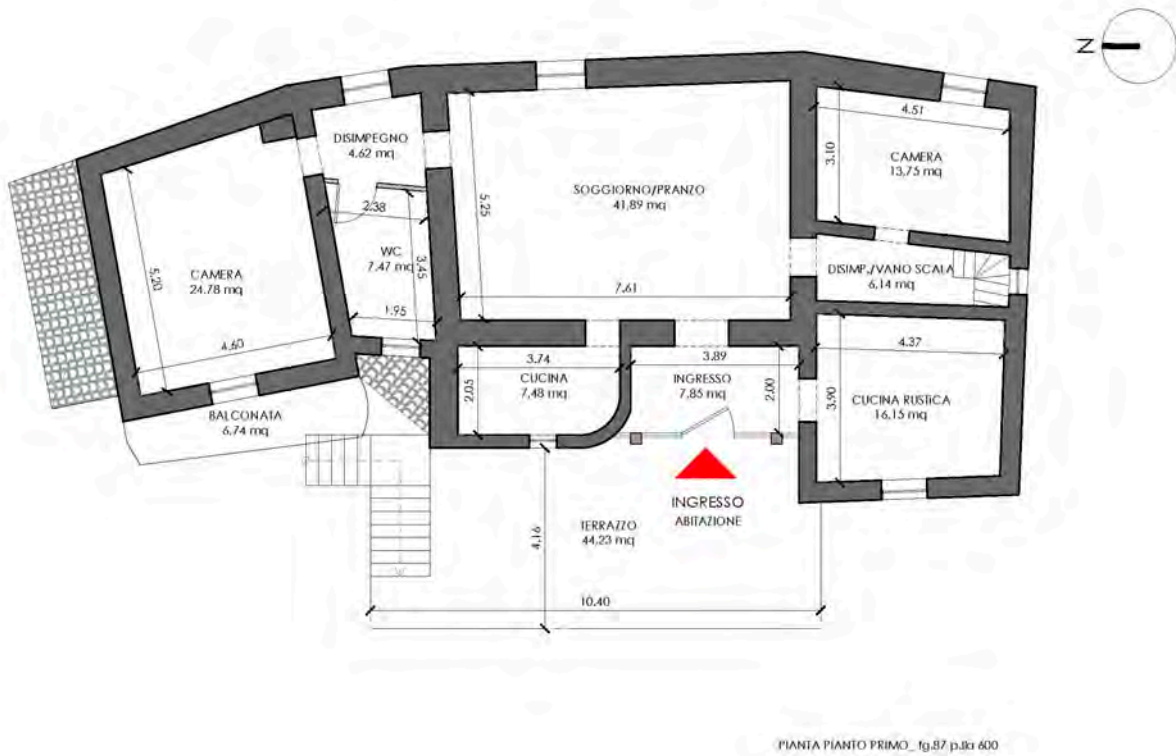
Rilievo Abitazione Lotto Uno Stato di fatto \_ pianta piano primo (Allegato 6D)
